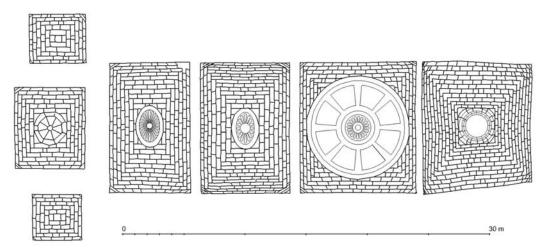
Planta general de bóvedas de la iglesia de Santa María de la Nava de Navamorcuende
